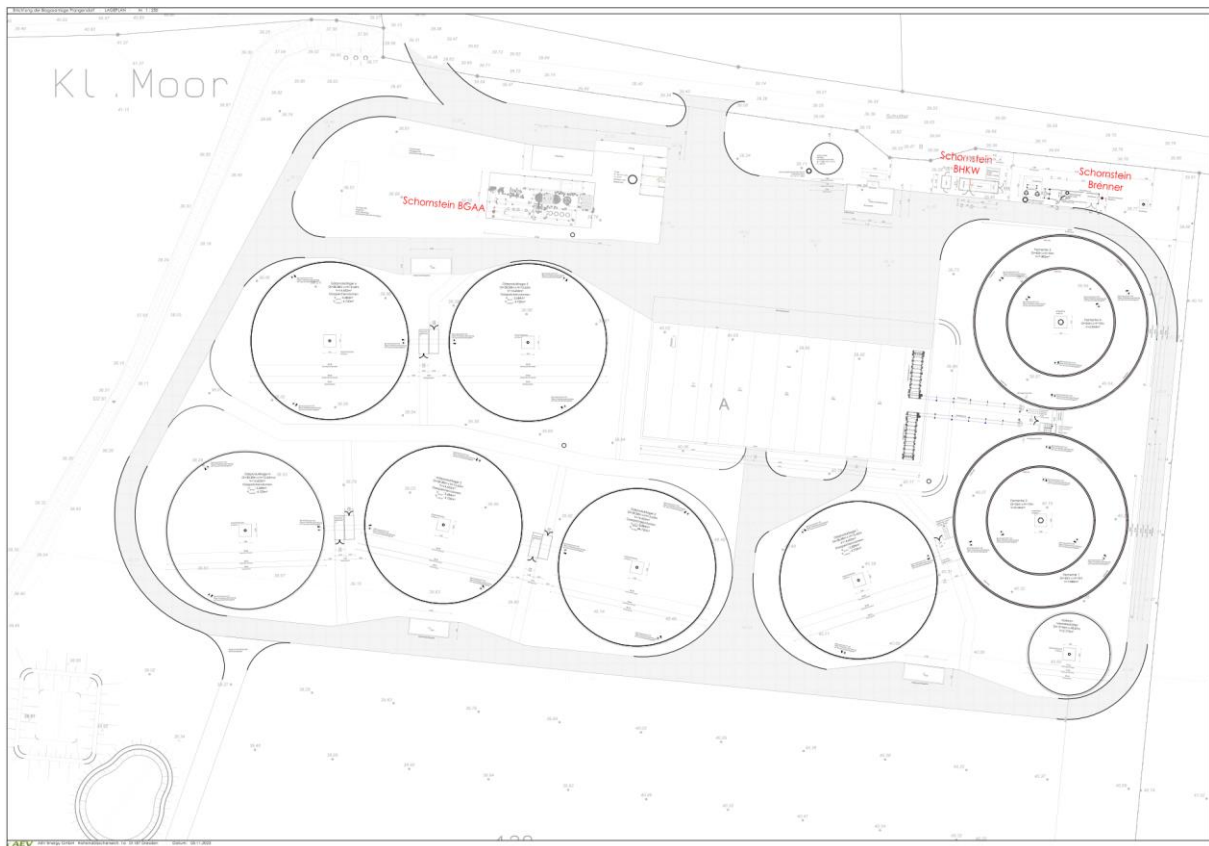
Lageplan der geplanten Anlage (AEV Energy GmbH, Dresden)
